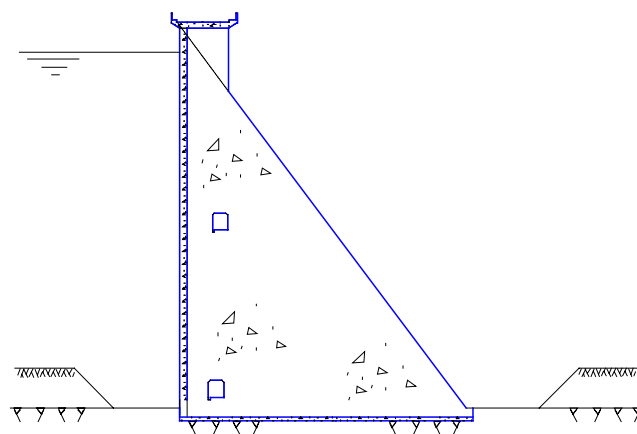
Seção típica de barragem de concreto compactado com rolo.
